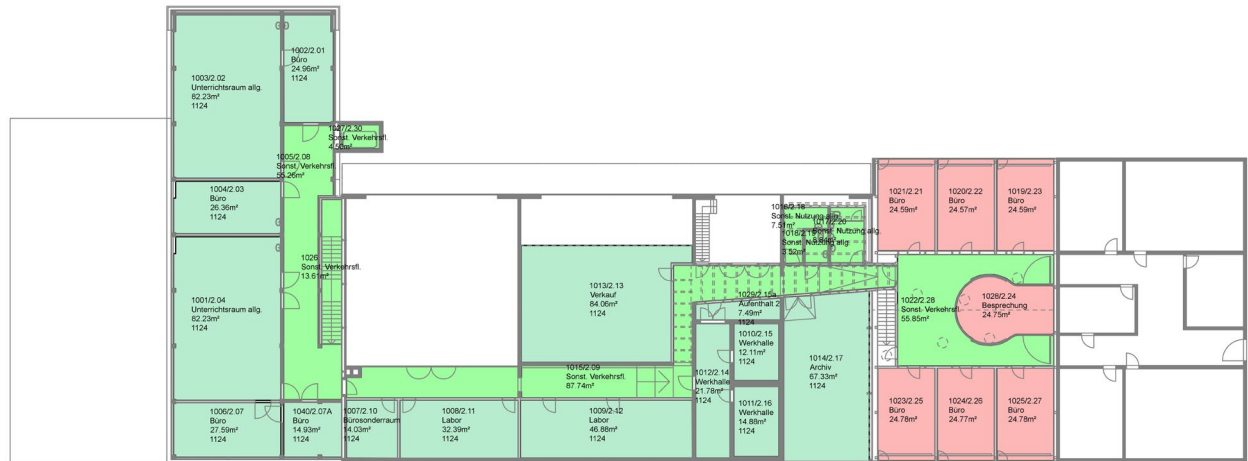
Grundriss Vauffelin 1.OG (grün BFH – rot DTC)
